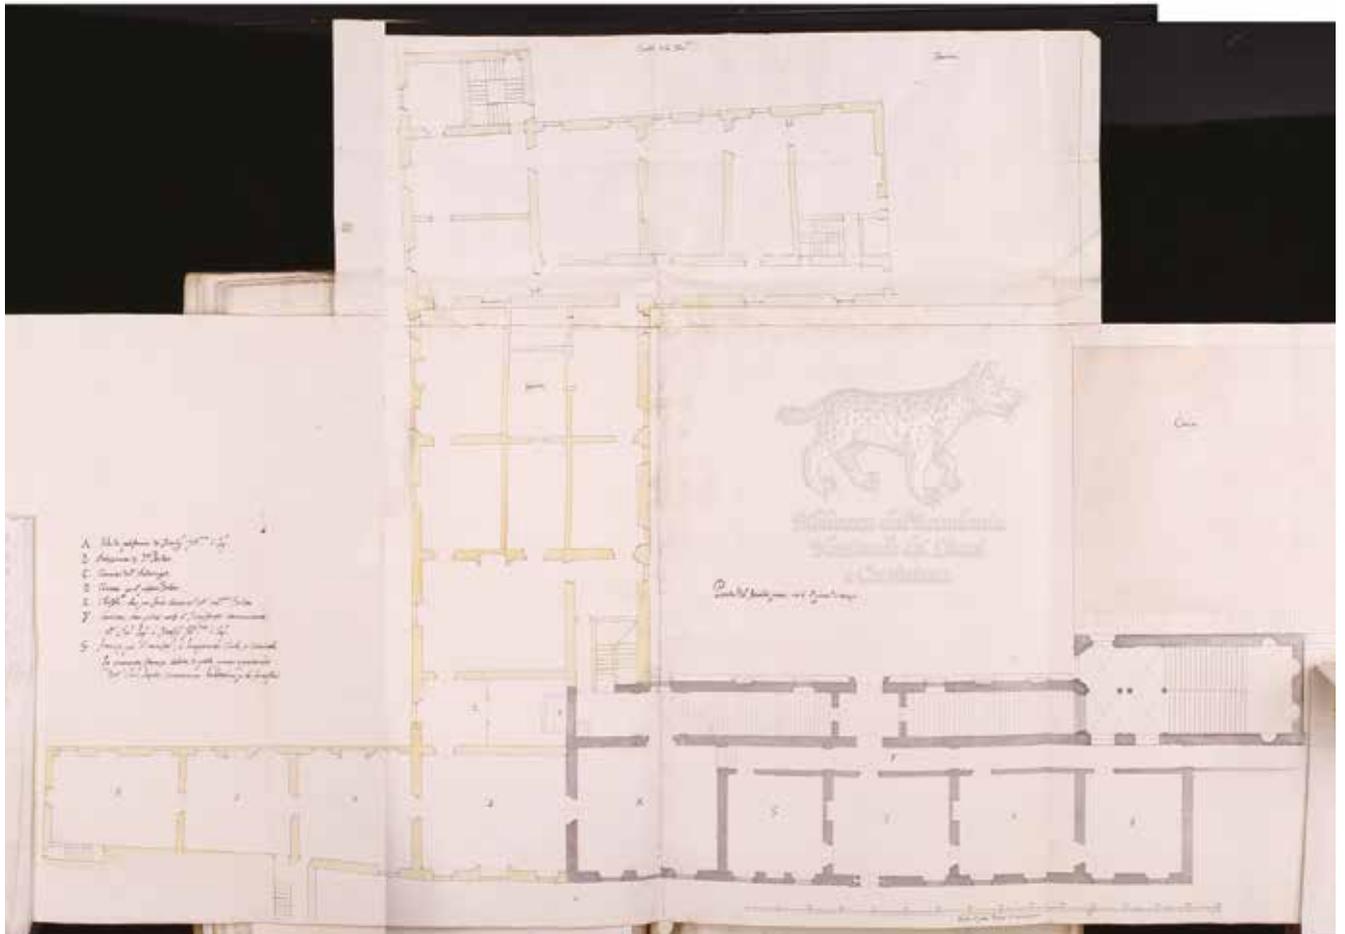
C.48 - BANLC, CORS. 34K-2, c. 29rA – Ravenna, Anonimo, Pianta piano primo del palazzo Apostolico di Ravenna, pianta (1696ca).
